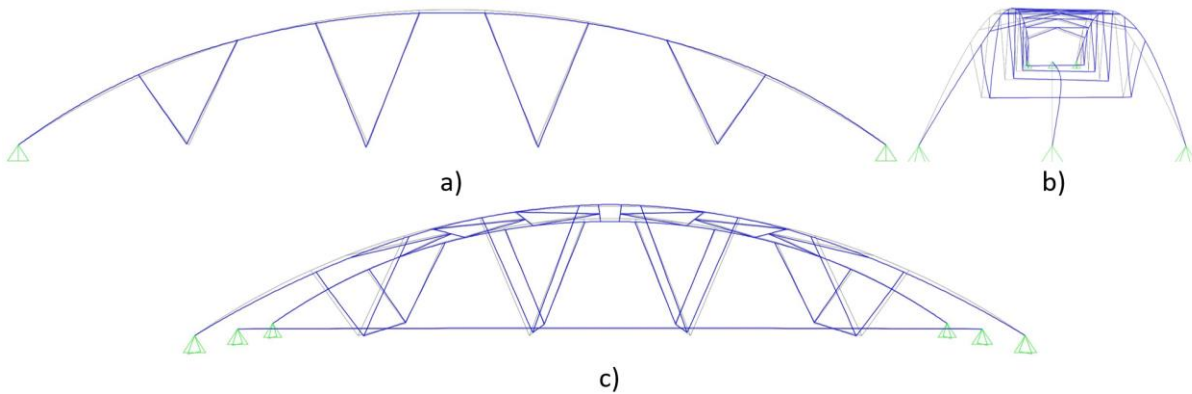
Modo de vibração 1 ( $f=1.072$  Hz;  $T=0.933$  s): a) alçado longitudinal; b) vista transversal 3D e c) vista longitudinal 3D
